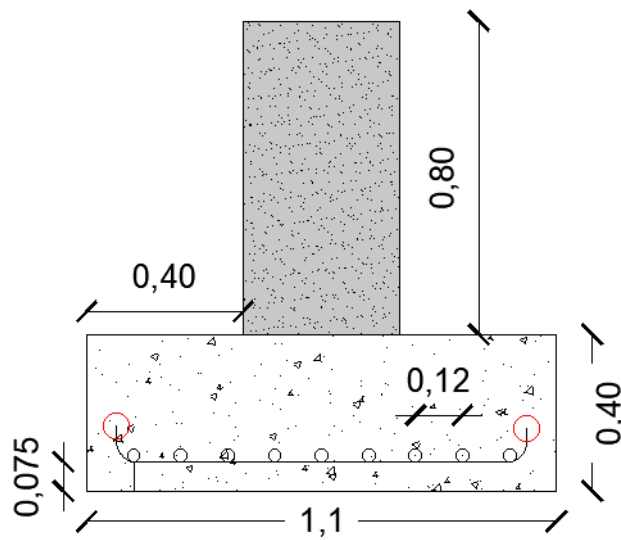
Detalle de zapata con valores - Vista en elevación
